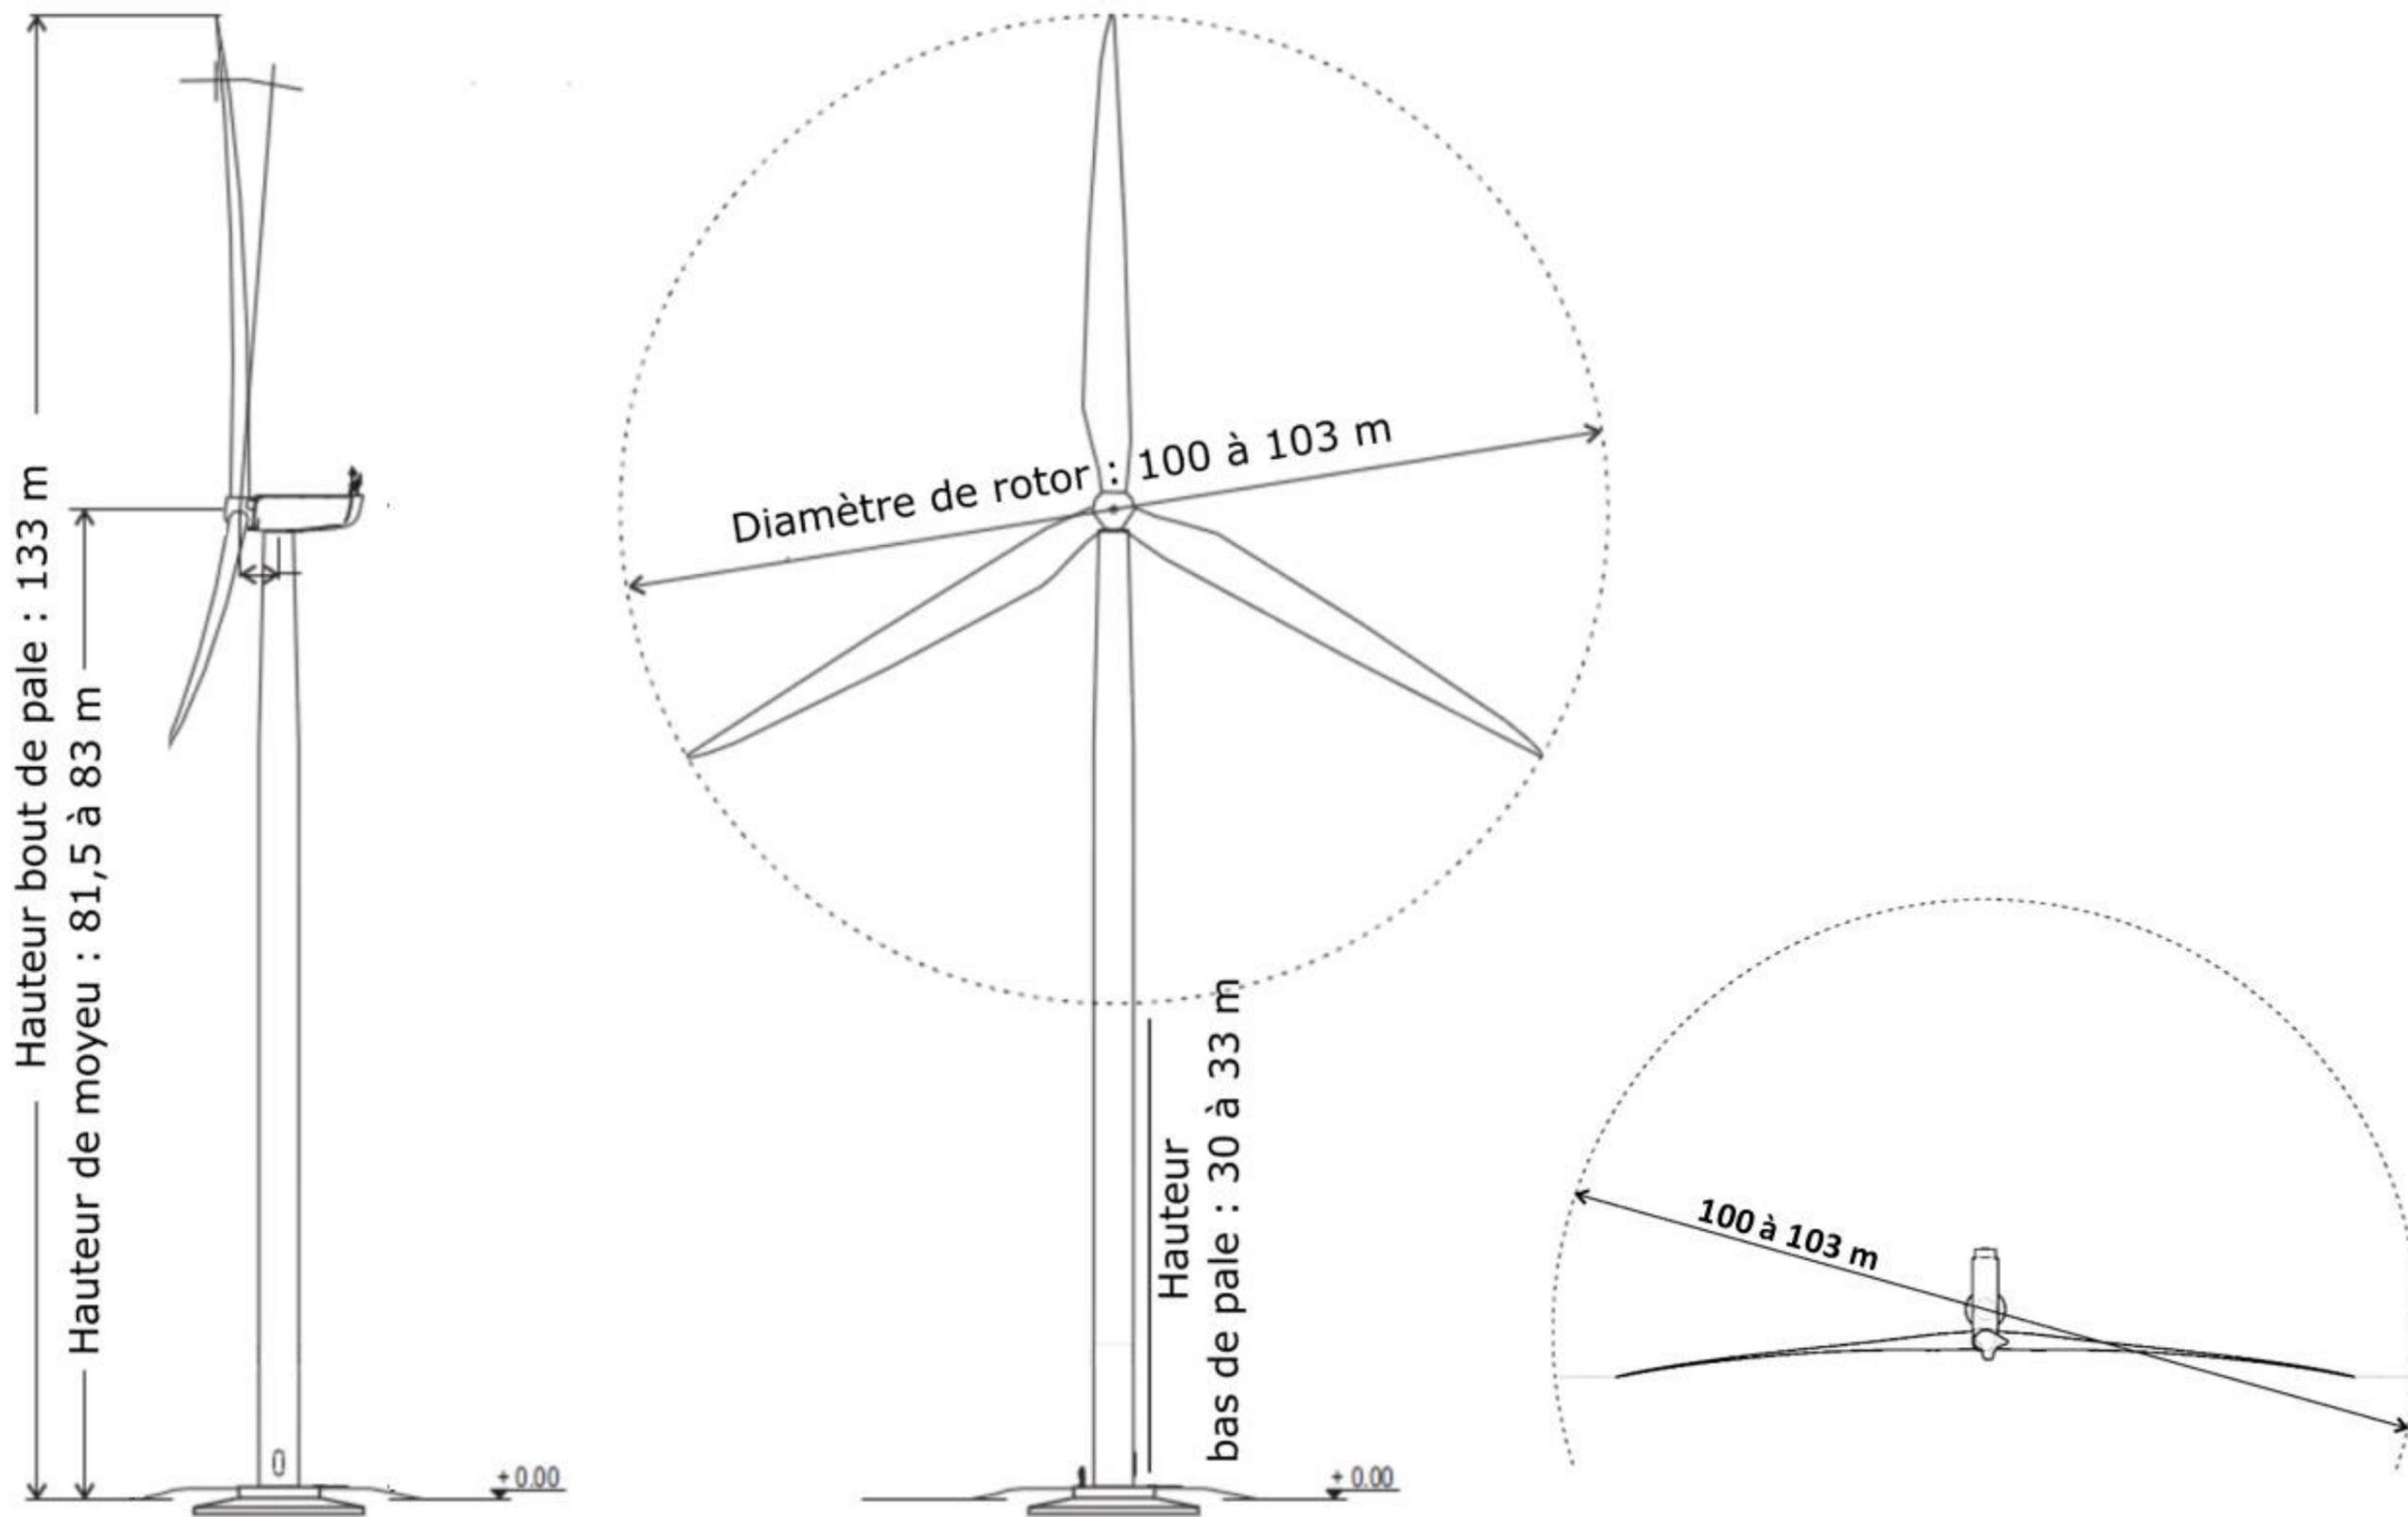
Plan d'élévation du Gabarit Type – 2/3 MW – 133 m
